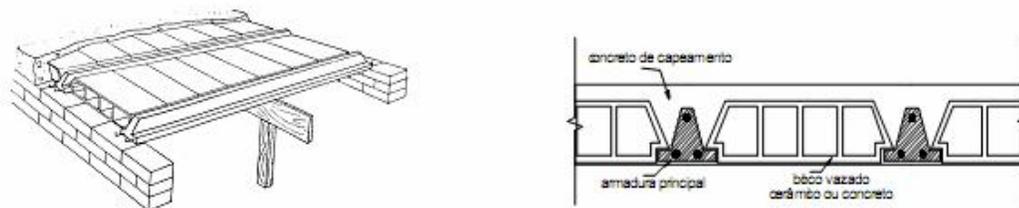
Laje pré fabricada convencional (vigotas do tipo trilho em concreto armado).
